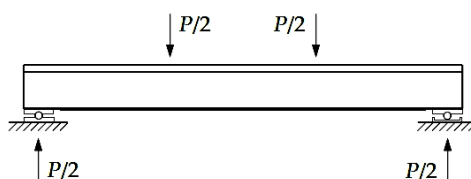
Esquema de forças do ensaio de das vigas de secção em T.
